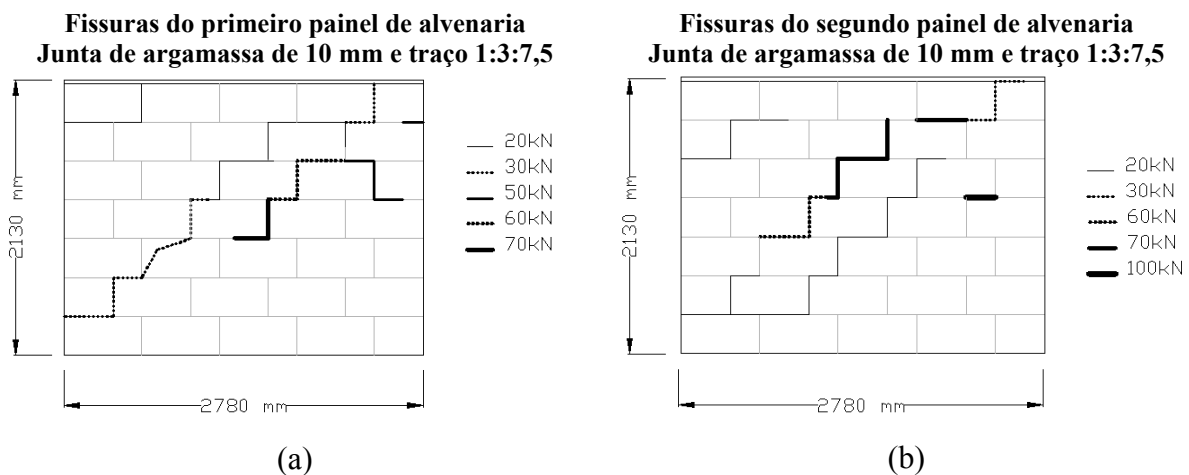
Mapeamento das fissuras: (a) ensaio 1; (b) ensaio 2.
